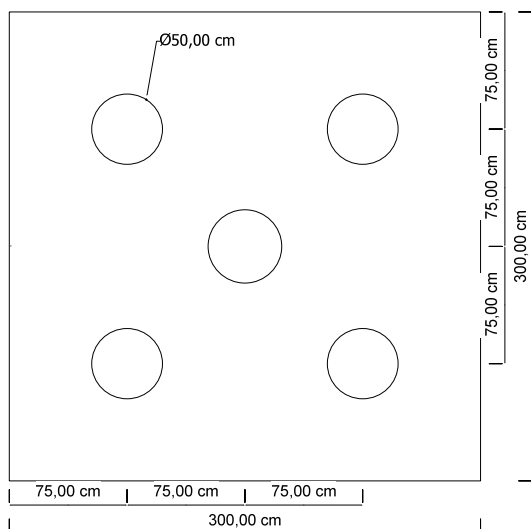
Betongrundkörper gemäß DIN EN 1766 [50]
